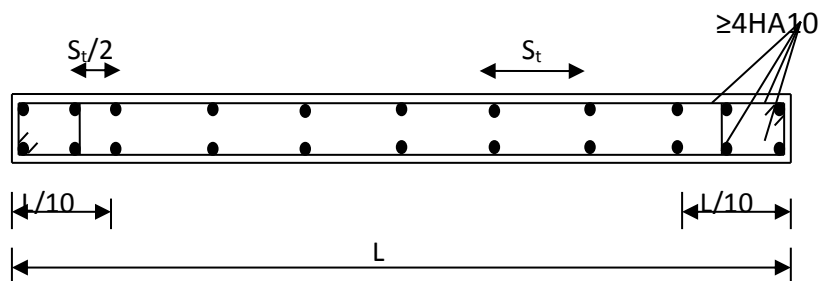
Disposition des armatures verticales dans les voiles.
